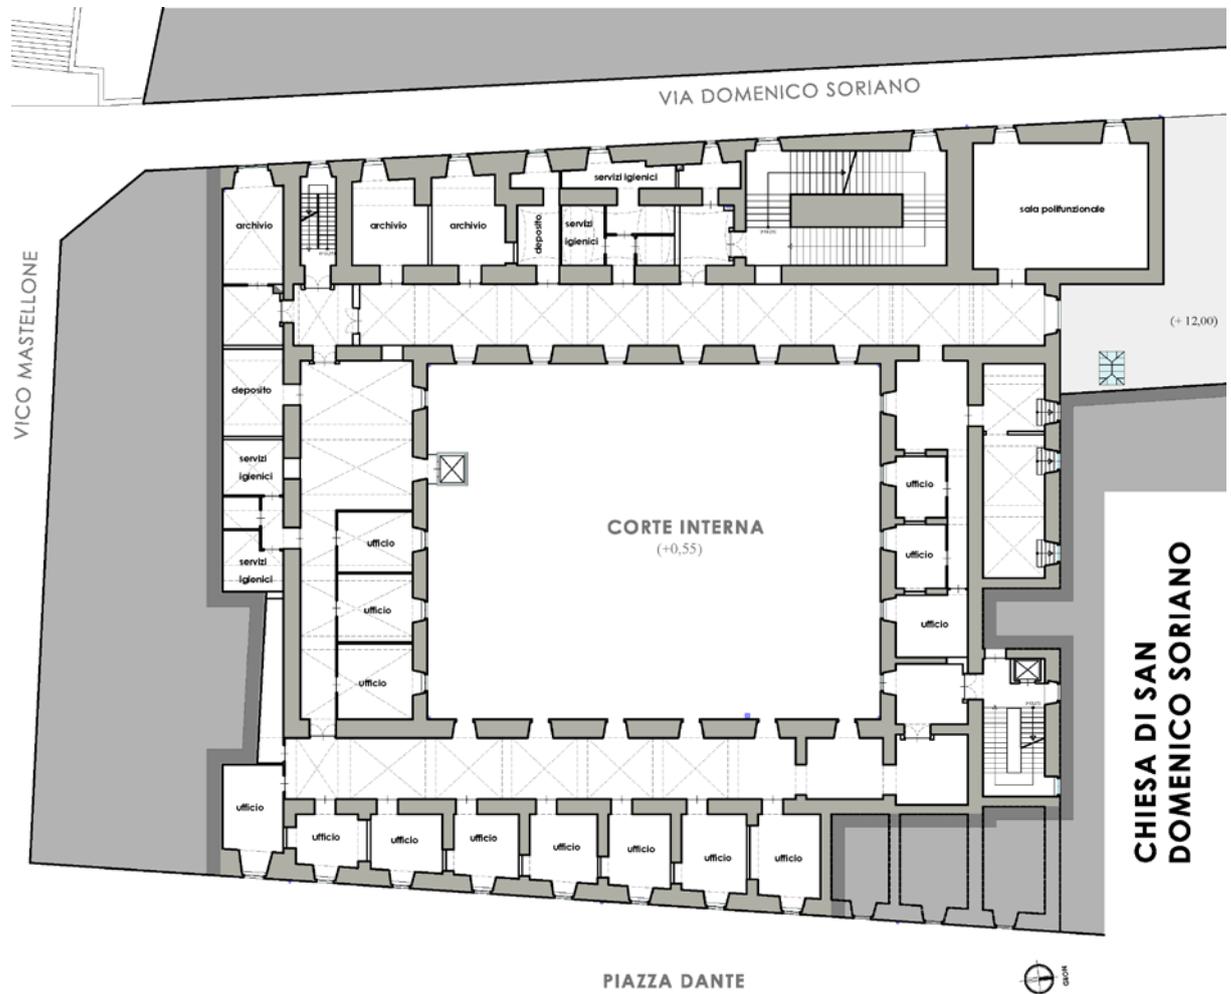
Indicazioni progettuali: Pianta Piano Secondo
